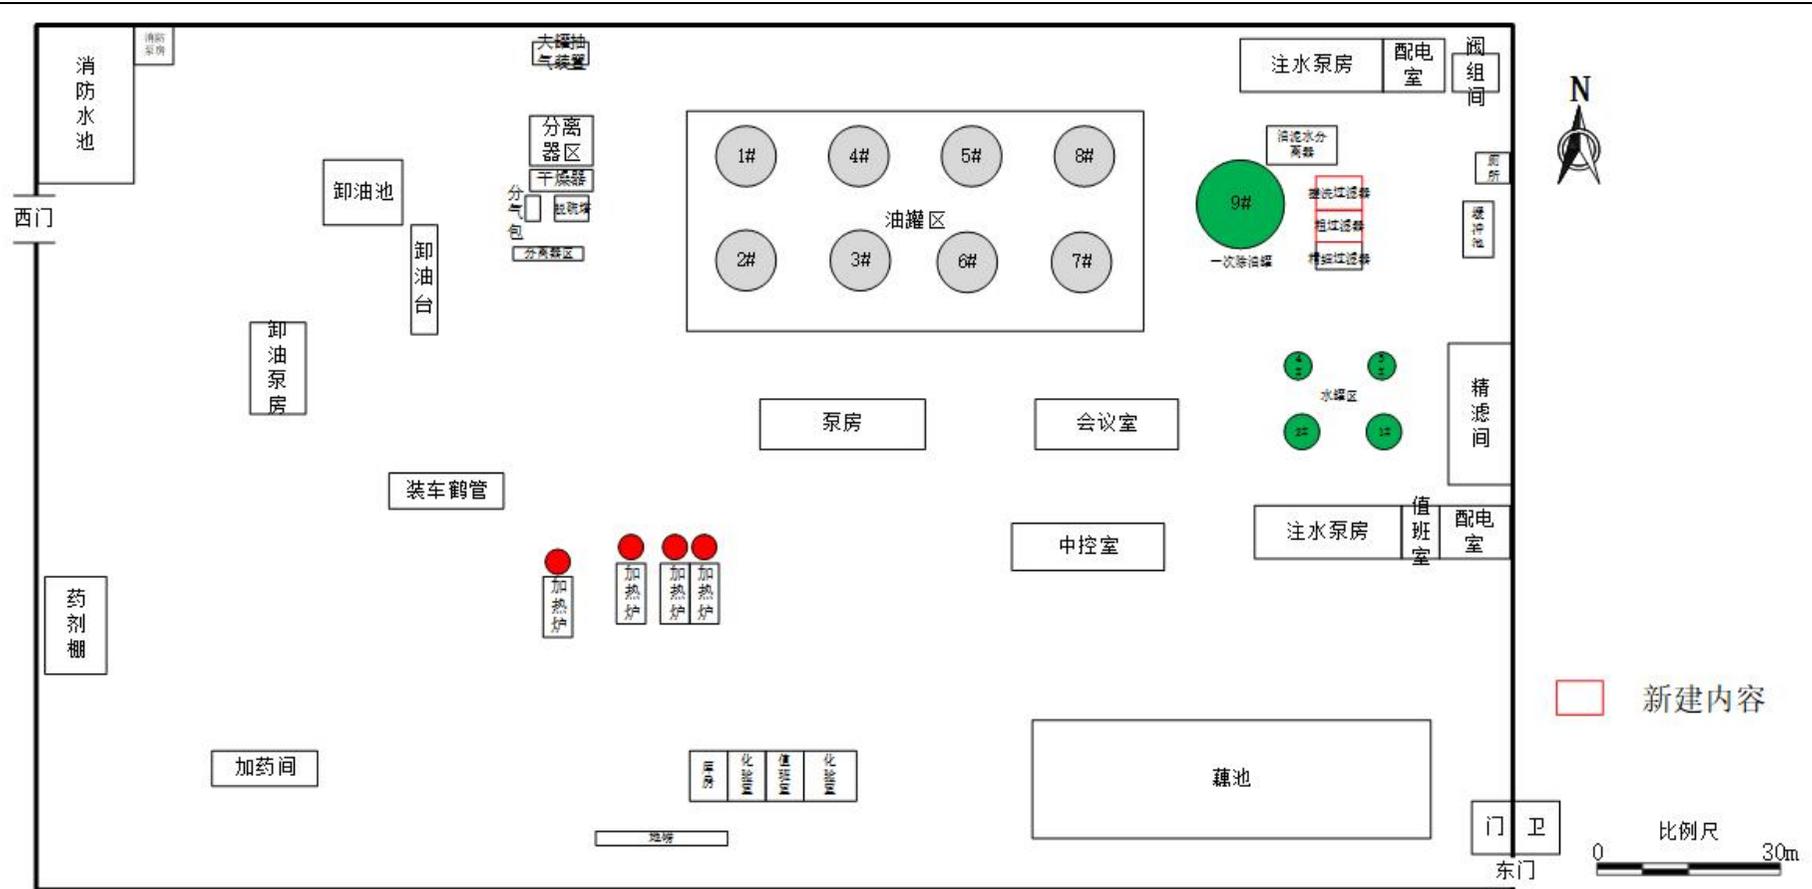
牛 25 联合站采出水处理系统改造后厂区平面布置图
